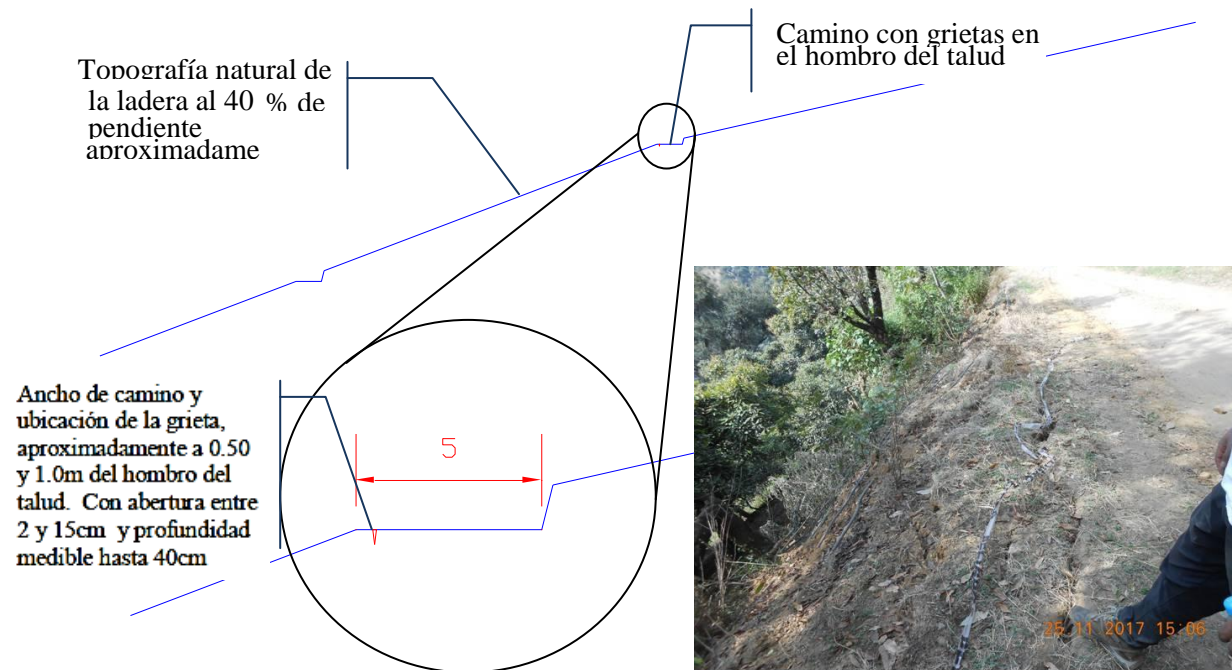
Detalle topográfico de la ladera y las grietas observadas en el camino a Lomas Lindas
